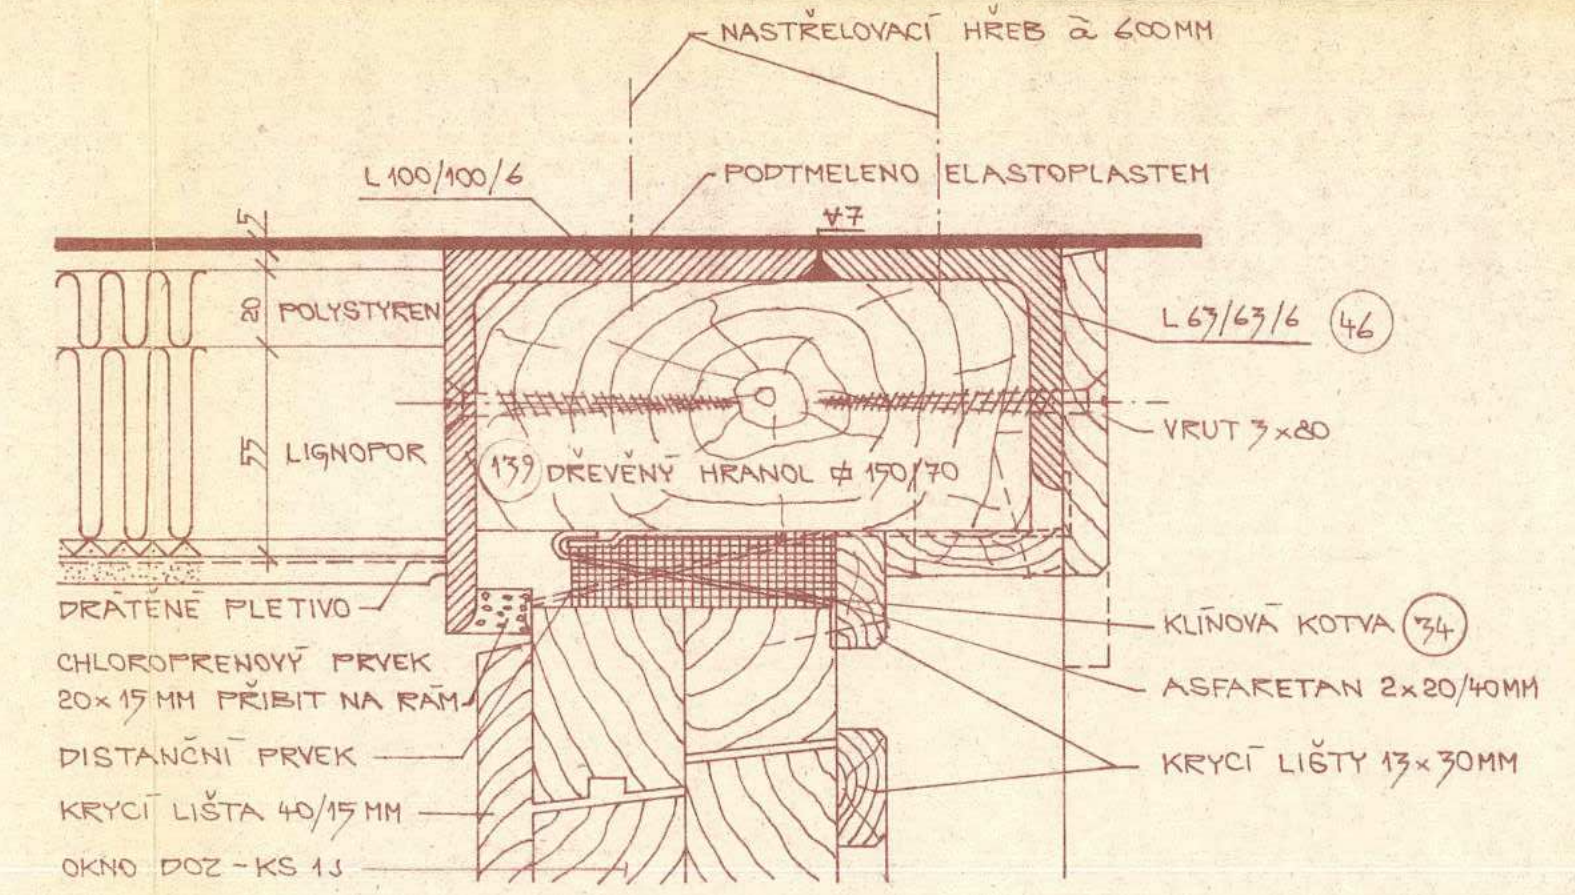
DETAIL OSAZENÍ OKEN A MIMO MONTOVANÝ PARAPETNÍ PANEĽ
